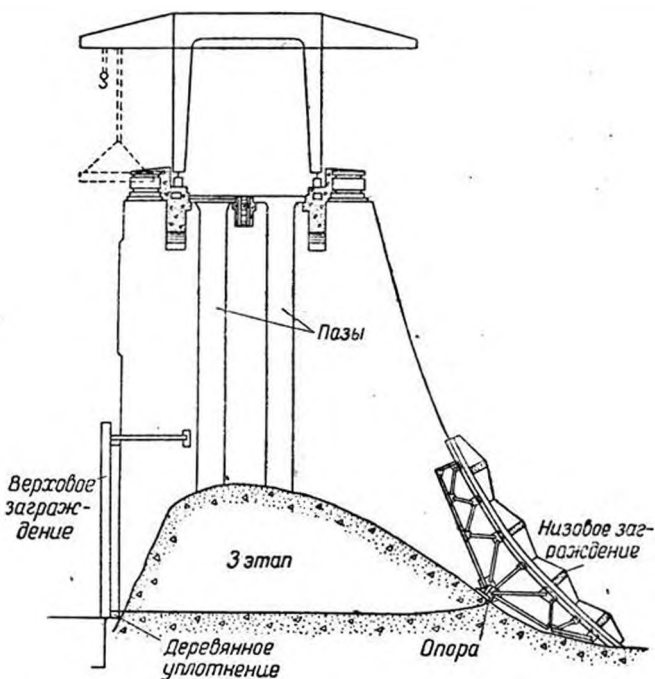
19. Переходная перемычка на бетонном флютбете плотины на р. Шексне
